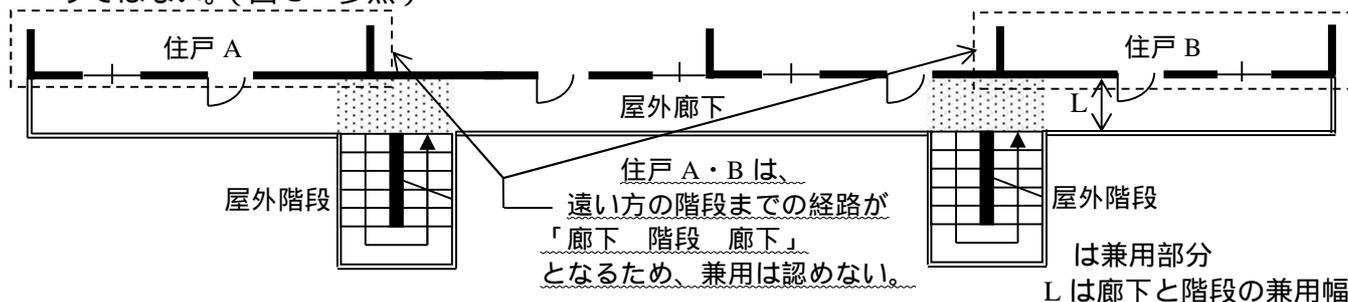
図A 屋外廊下に面して設ける屋外階段・エレベーター等の平面図
